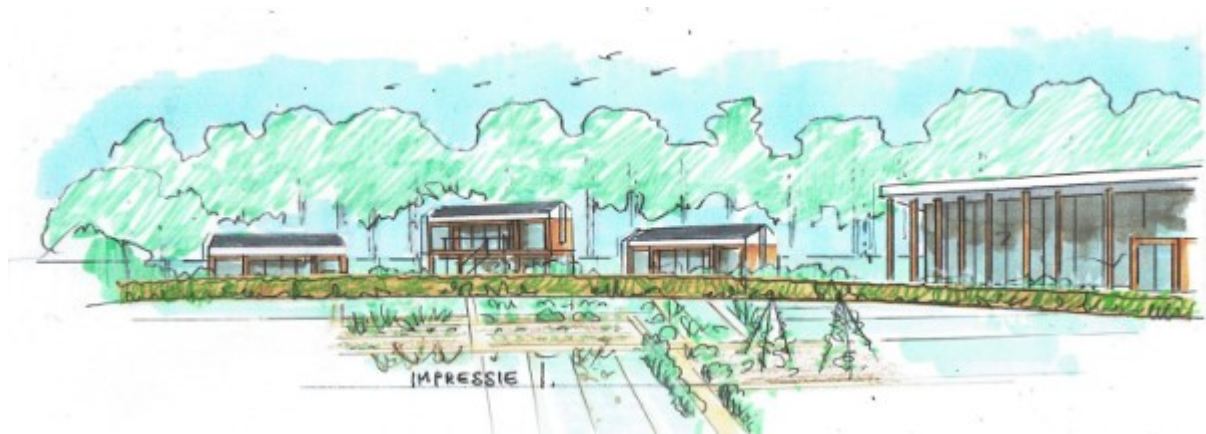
Impressie rechter zijgevel paviljoen (zijde Haareweg)
